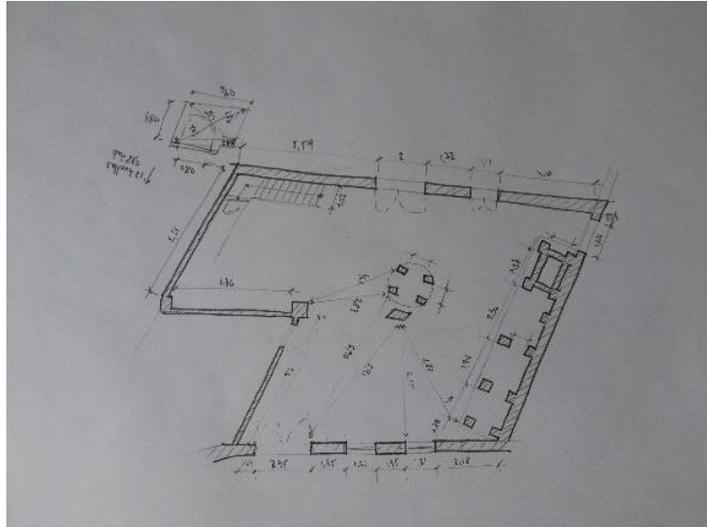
Croquizado de almacén planta baja. Fuente Propia.
